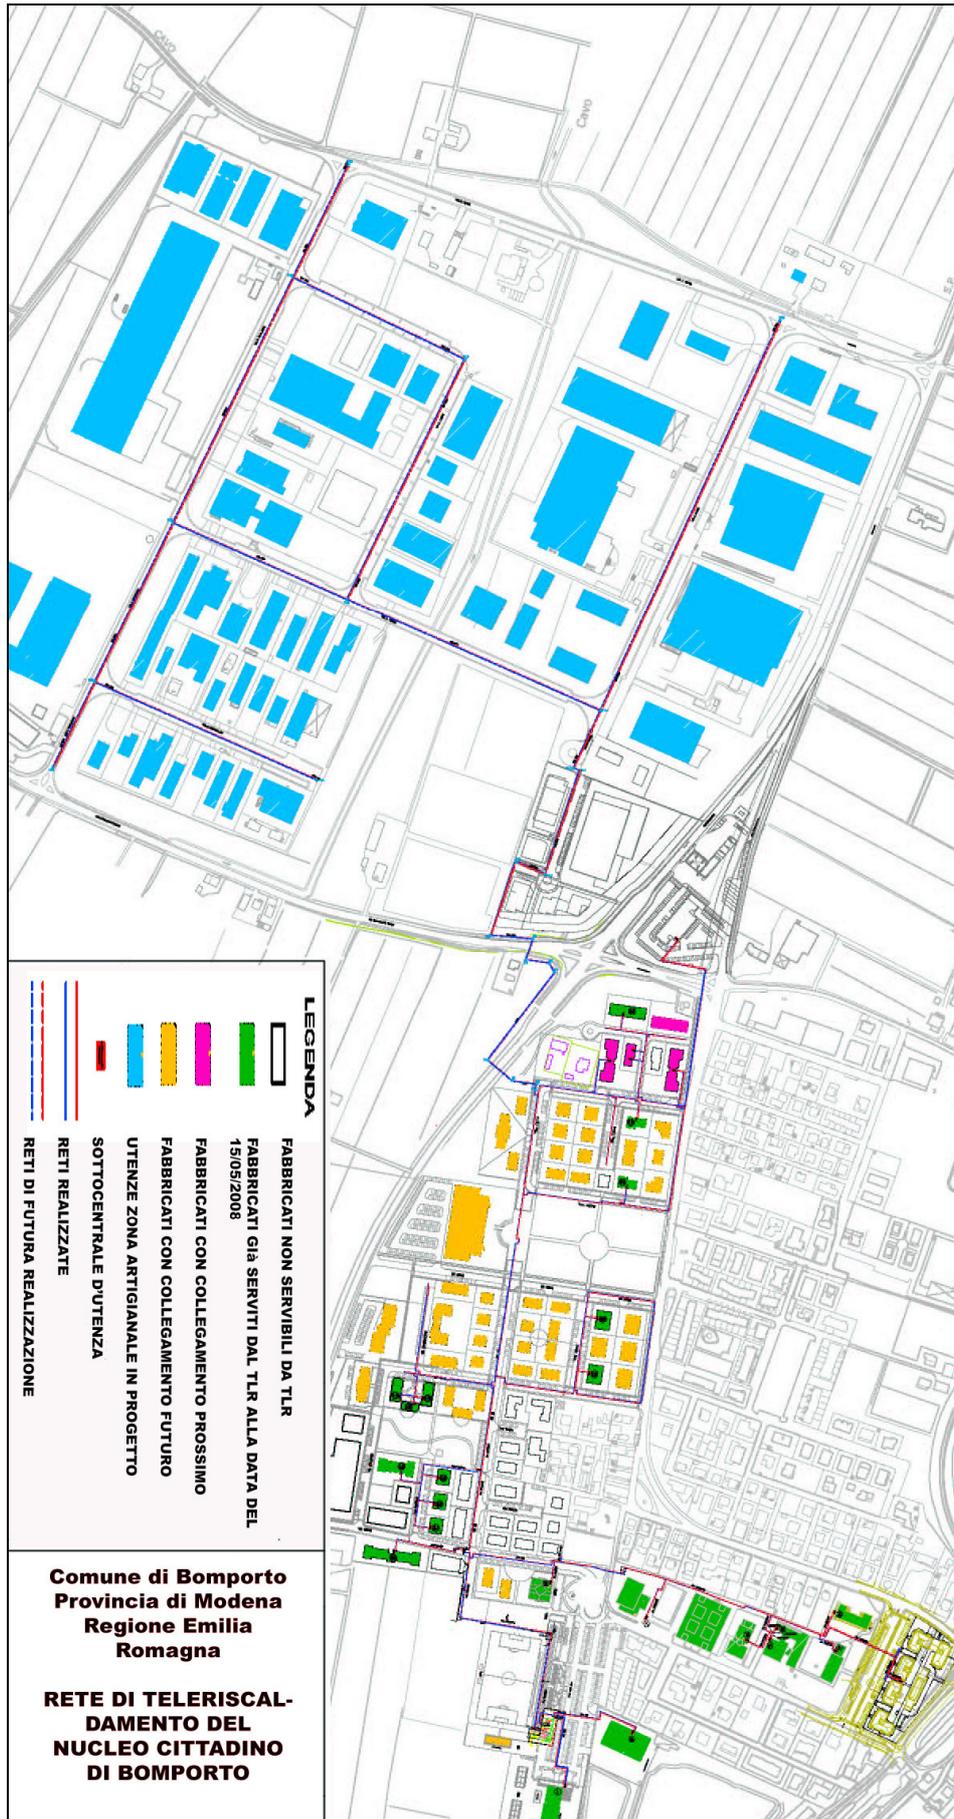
Planimetria Teleriscaldamento Bomporto
